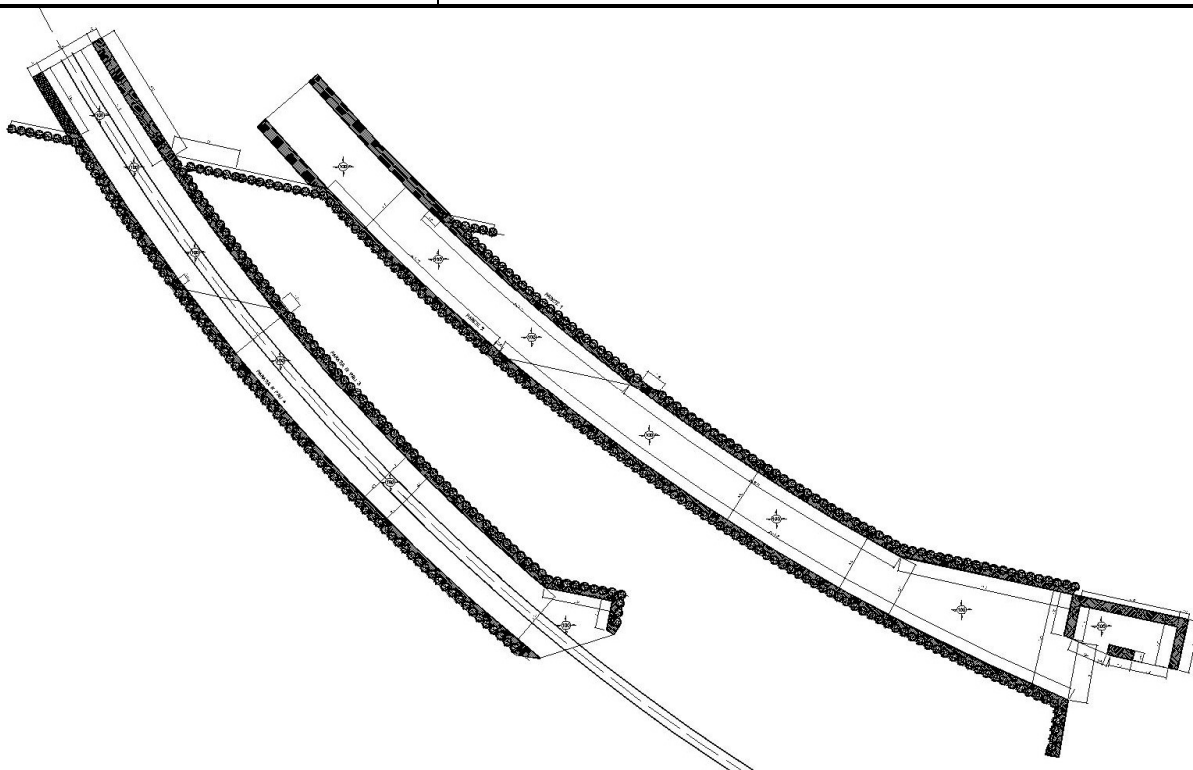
Pianta delle galleria, carpenteria solettone superiore
